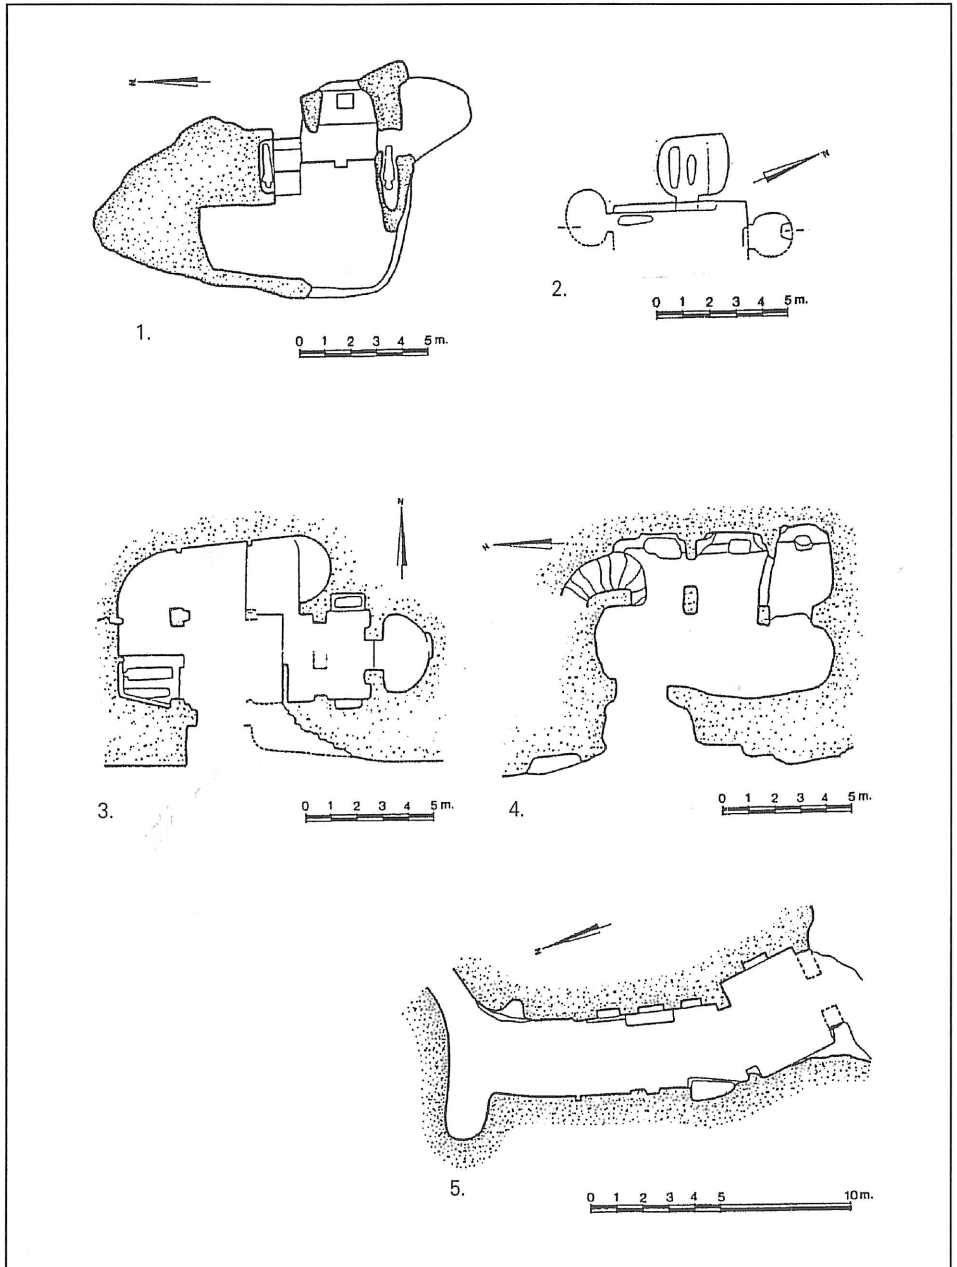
1. Ermita de San Vicente. Cervera de Pisuerga (Palencia). Planta (según: Alcalde Crespo). 2. Laño-Las Globas (Prov. Burgos). Planta (según: Azkarate Garai-Olaun). 3. San Pedro. Argés (Burgos). Planta (según: Monreal Jimeno). 4. Ermita de San Miguel. Las Presillas (Burgos). Planta (según: Monreal Jimeno). 5. Siete Altares (Segovia). Planta (según: Iñiguez Almech)
